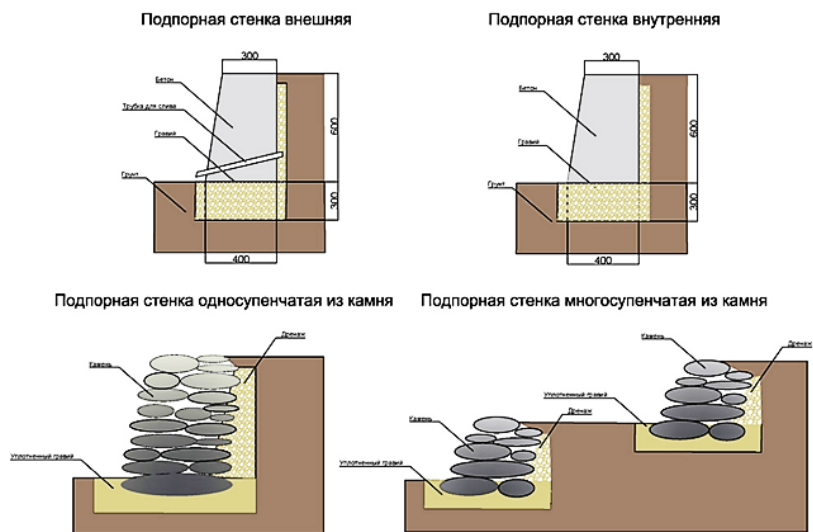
Конструкции подпорных стенок из бетона и камня
